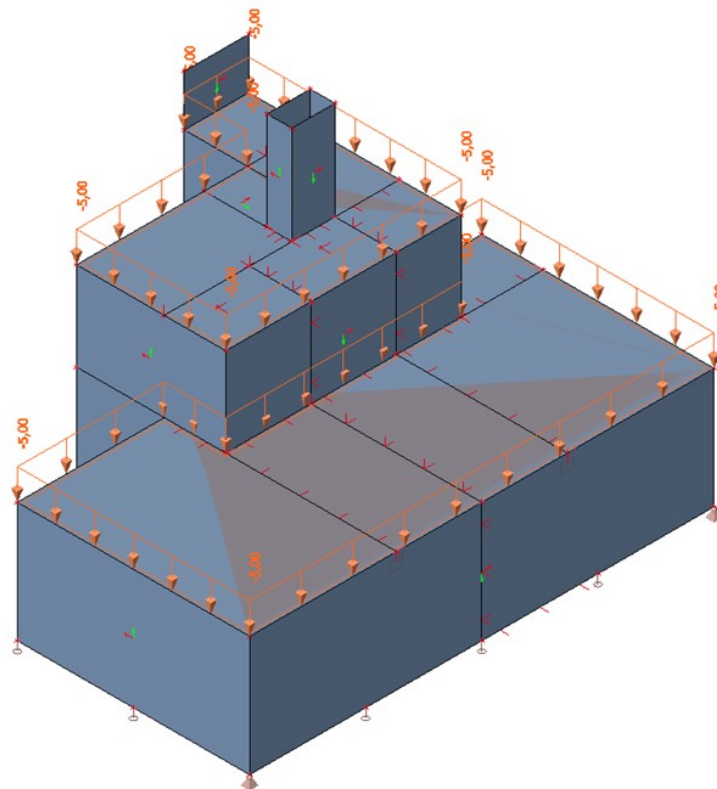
zatížení konstrukce vybavením (schodiště, manipulační háky, baterie)
